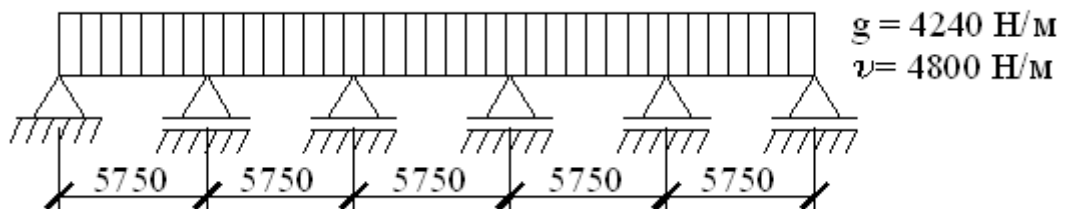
Розрахункова схема плити в напрямі  $l_2$
